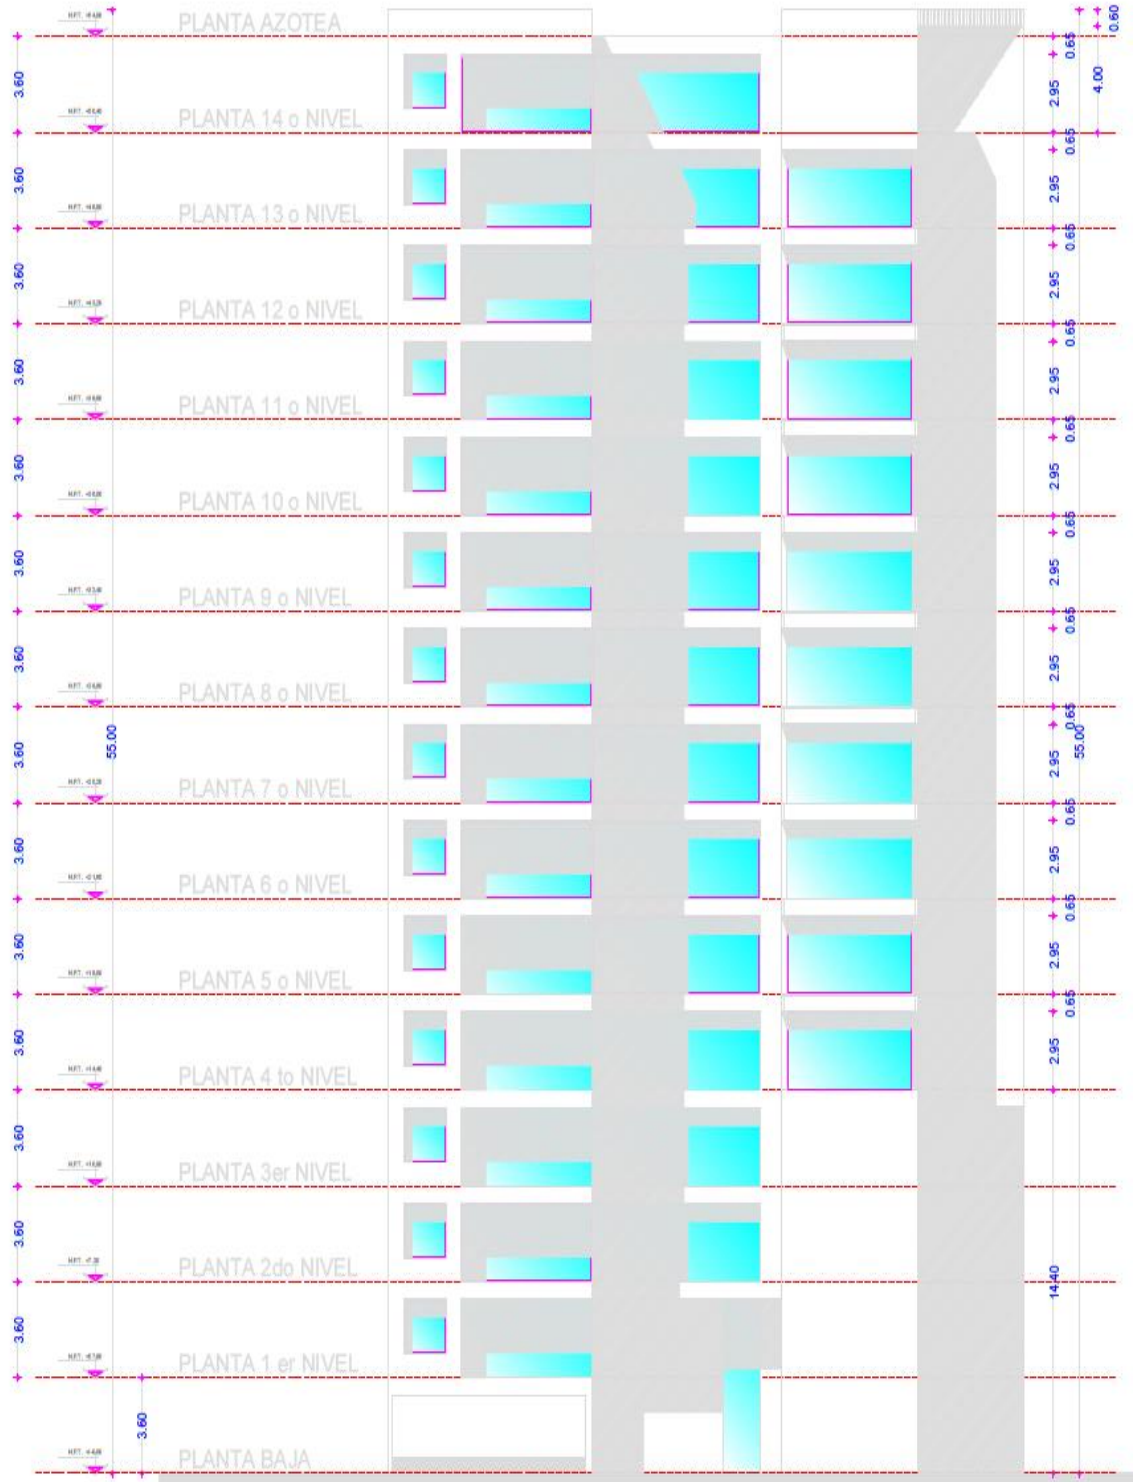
B.- FACHADA ARQUITECTÓNICA
